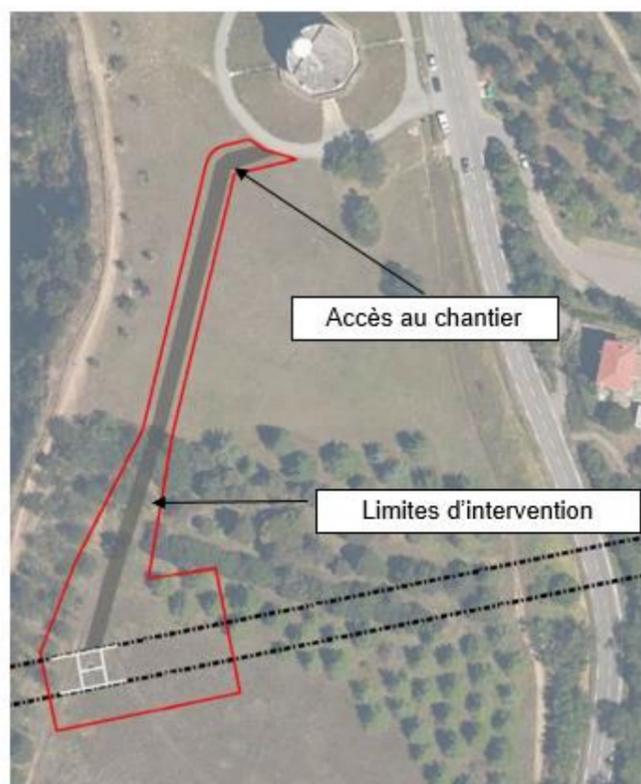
Plan de localisation des travaux de mise en place du P2 (source : Groupement POMA, 2017)
